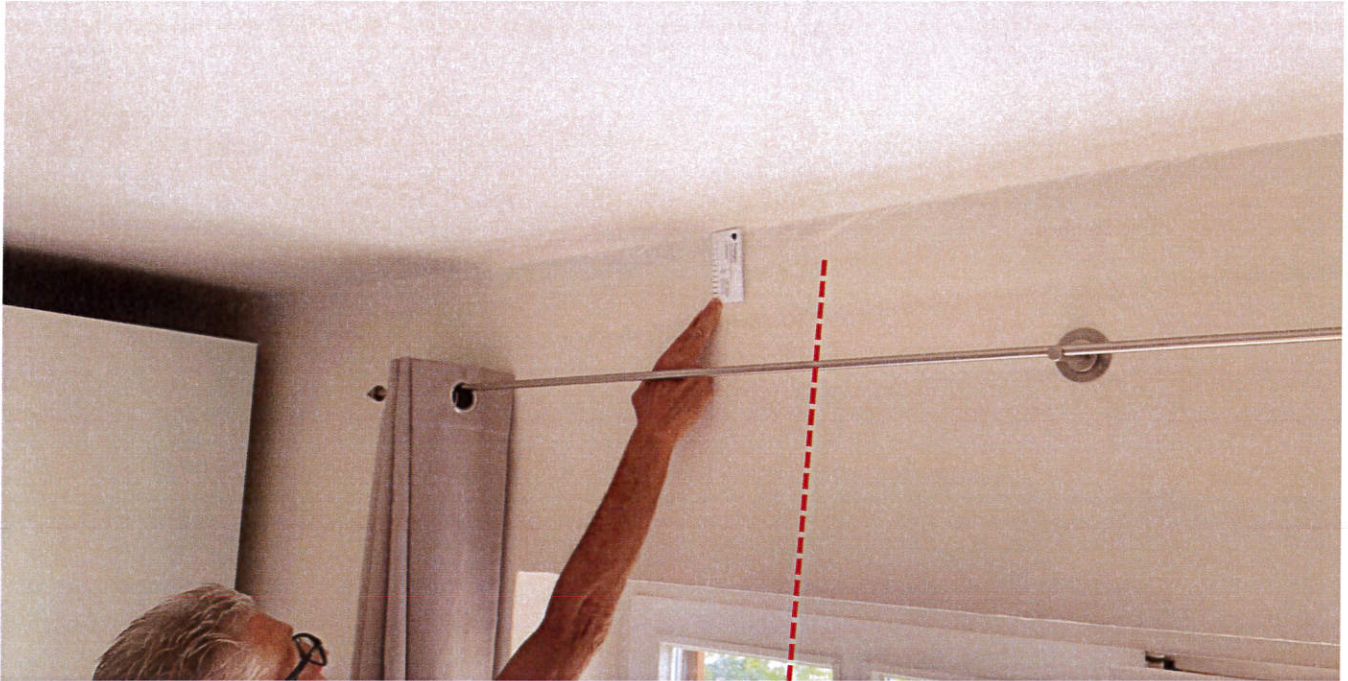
13.08.2020_Das im Dachgeschoss in der Holzbalkendecke versickerte Wasser trat an der Deckenuntersicht über dem OG an den Außenwänden aus.
